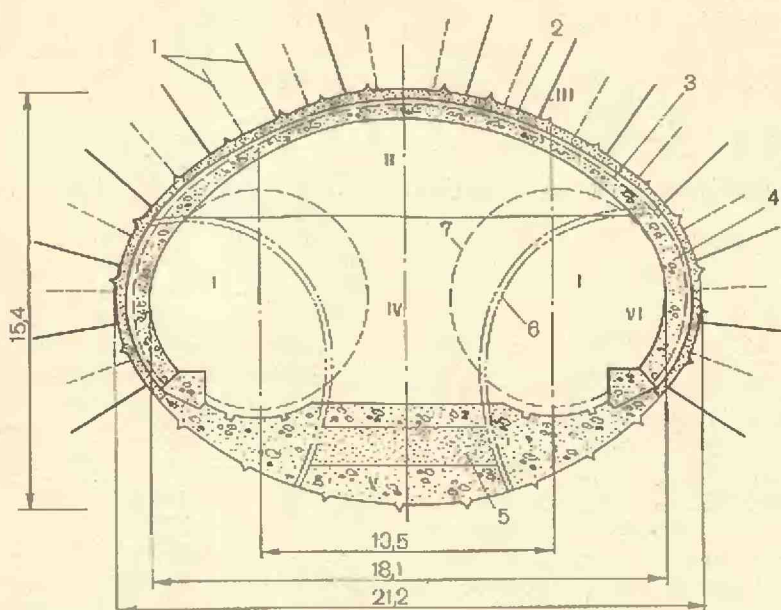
Технологическая последовательность сооружения подземной камеры: I—VI — этапы работ; 1 — скальные анкеры; 2 — первичная крепь из набрызгбетона; 3 — гидроизоляция; 4 — вторичная крепь из монолитного бетона; 5 — засыпка; 6 — контур опережающих штролов; 7 — контур путевых гонимелей.
